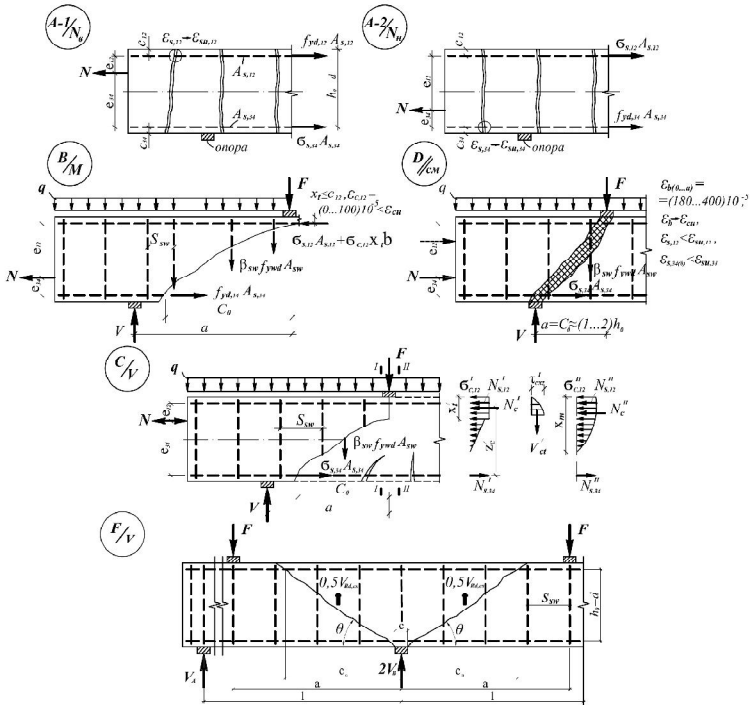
Основні схеми руйнування однопрогінних позакентрово розтягнутих і стиснутих, звичайних та поперечно напружених залізобетонних балок
